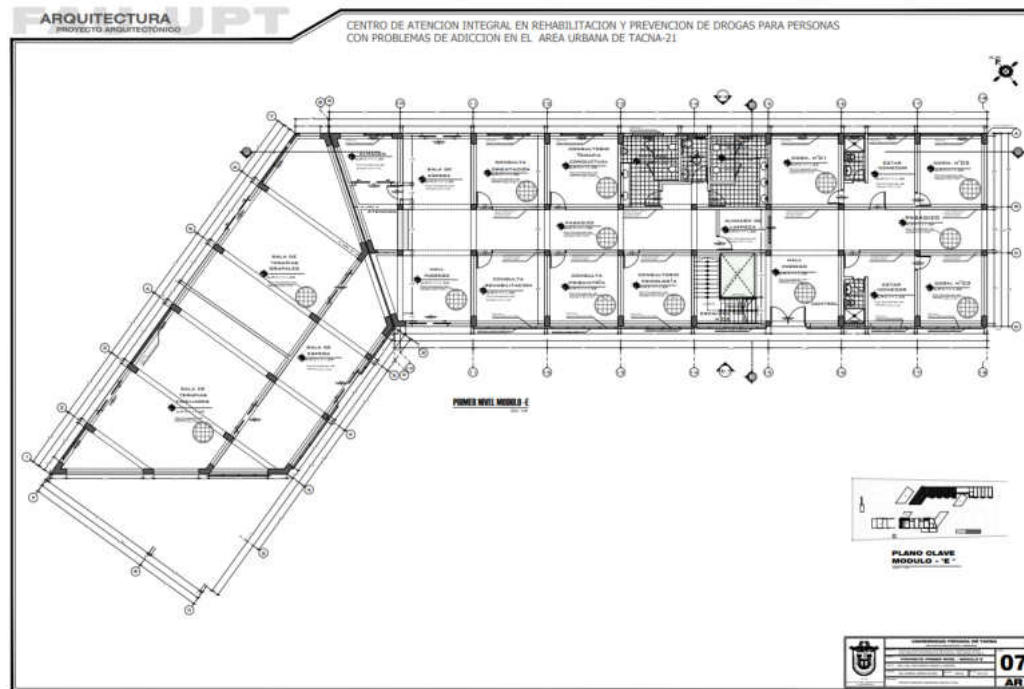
Plano primer nivel bloque E, fuente elaboración propia.
